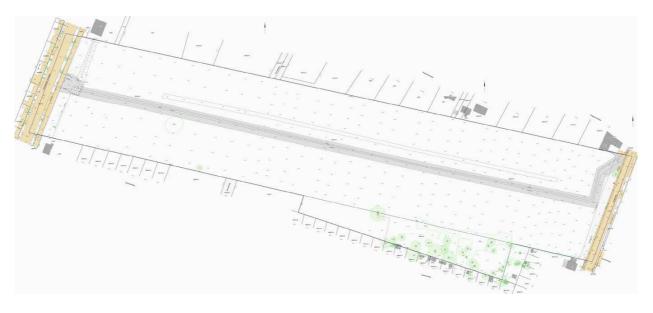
Lageplan mit Grunddienstbarkeiten (graue Fläche)
